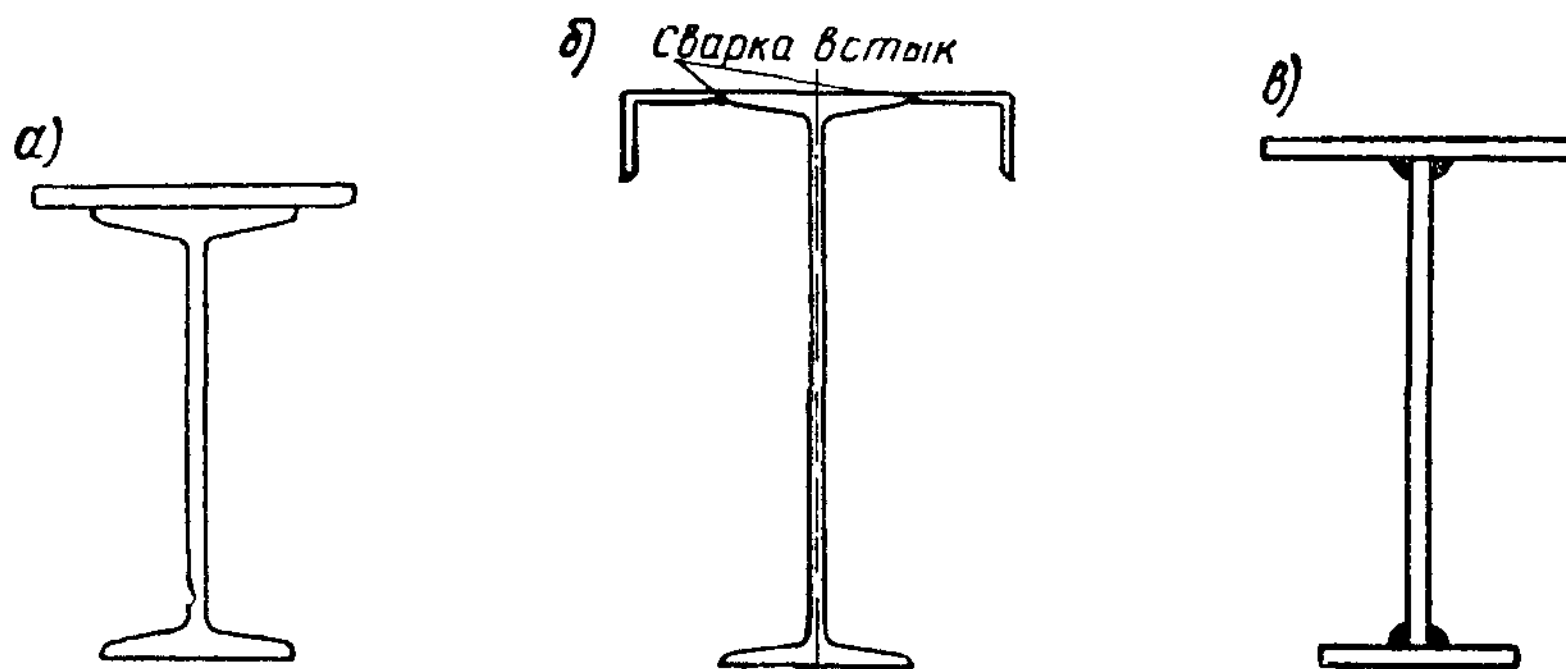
Развитие верхнего пояса подкрановой балки в горизонтальной плоскости
